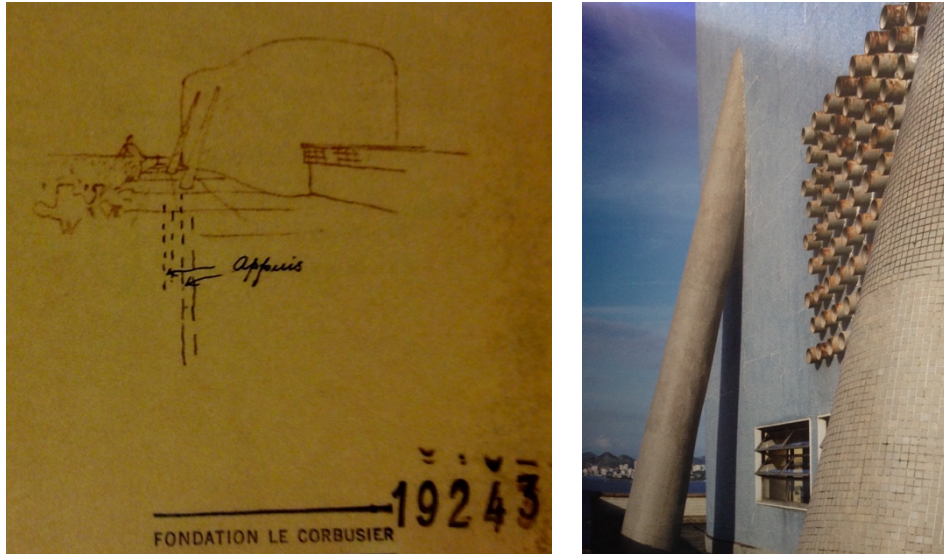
e 336 – Perspectiva em desenho detalhando a caixa d'água. Foto do detalhe do pilar inclinado. Fonte: CAVALCANTI, p. 130, 2014 e SEGRE, p.293, 2014.
